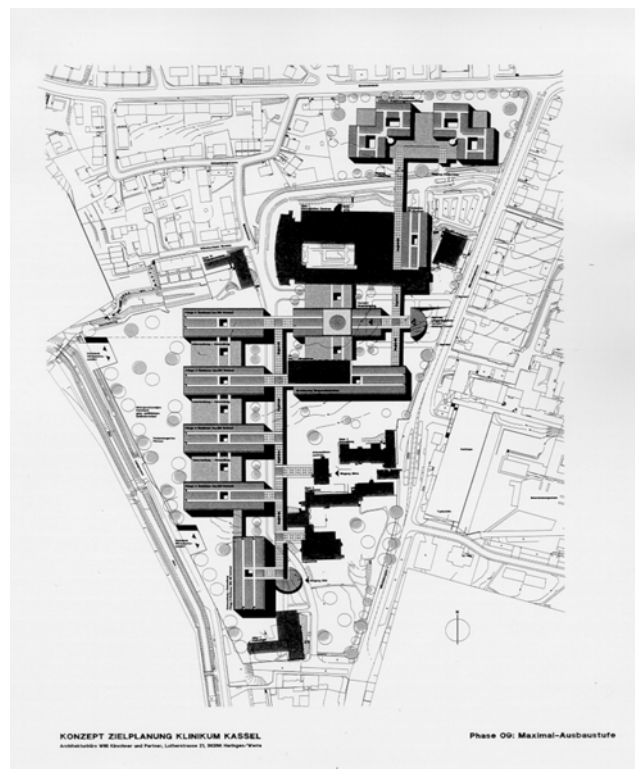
Typische Pavillonstruktur eines großen Krankenhauses und Zentralisierung im Rahmen der baulichen Zielplanung
